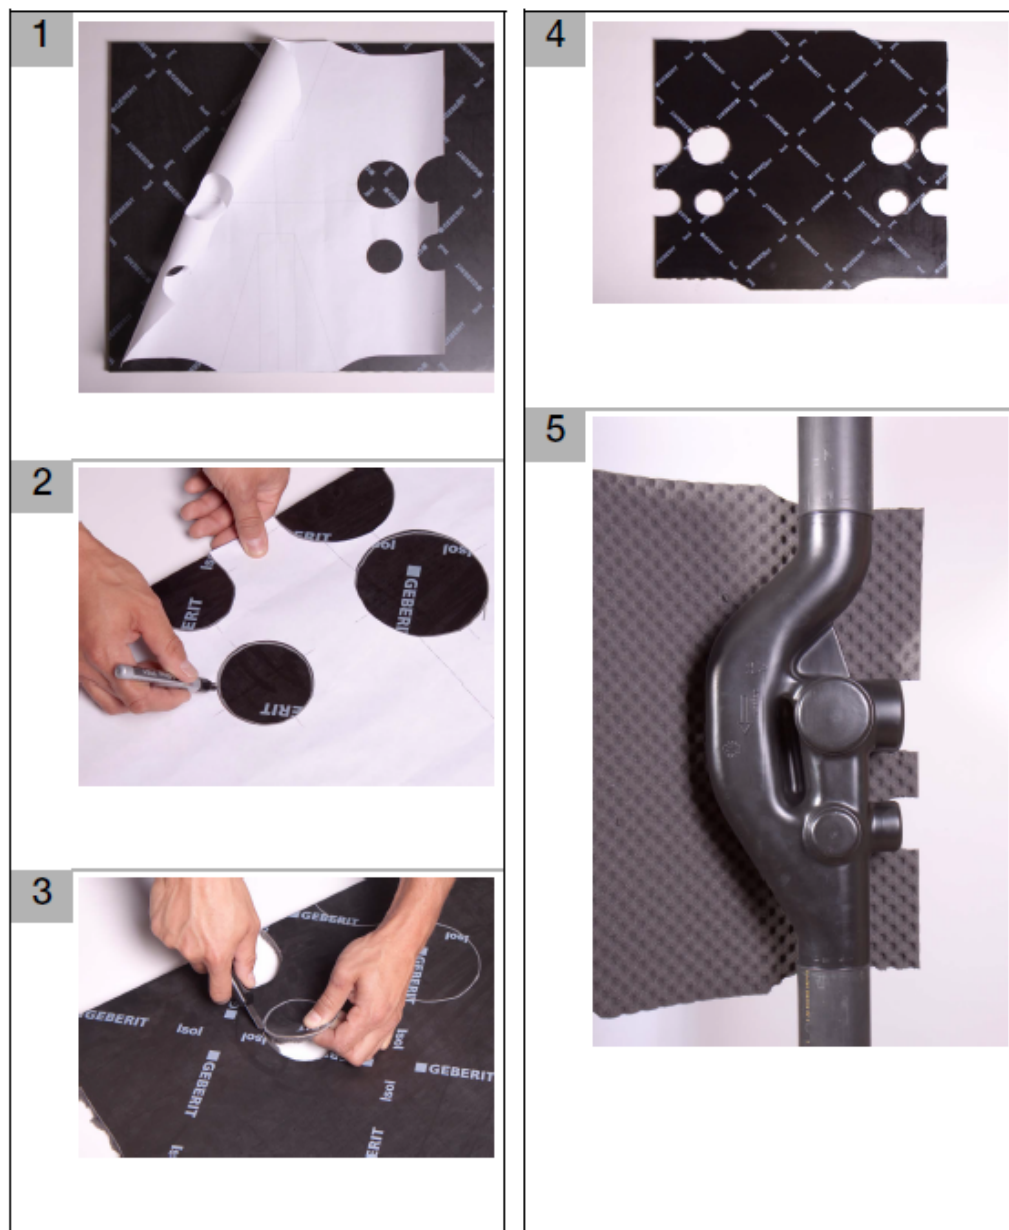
Exemple d'installation du matelas isolant Geberit Isol Flex sur la culotte Geberit Sovent
